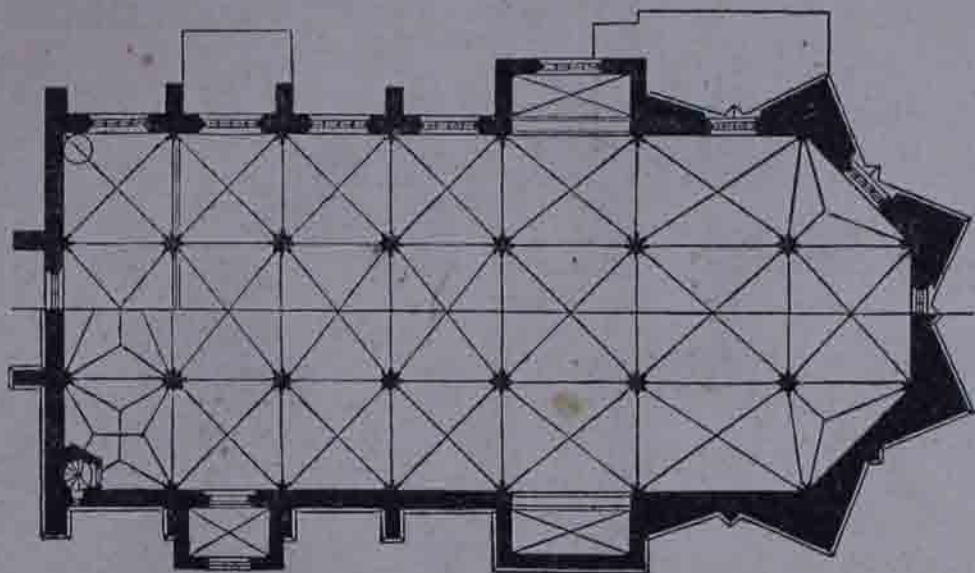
, Mödling, Pfarrkirche; Grundriß.
